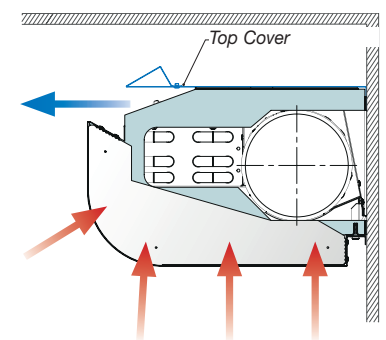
Plafond XD-FW Montage an der Wand, mit Abstand zur Decke (FW).
